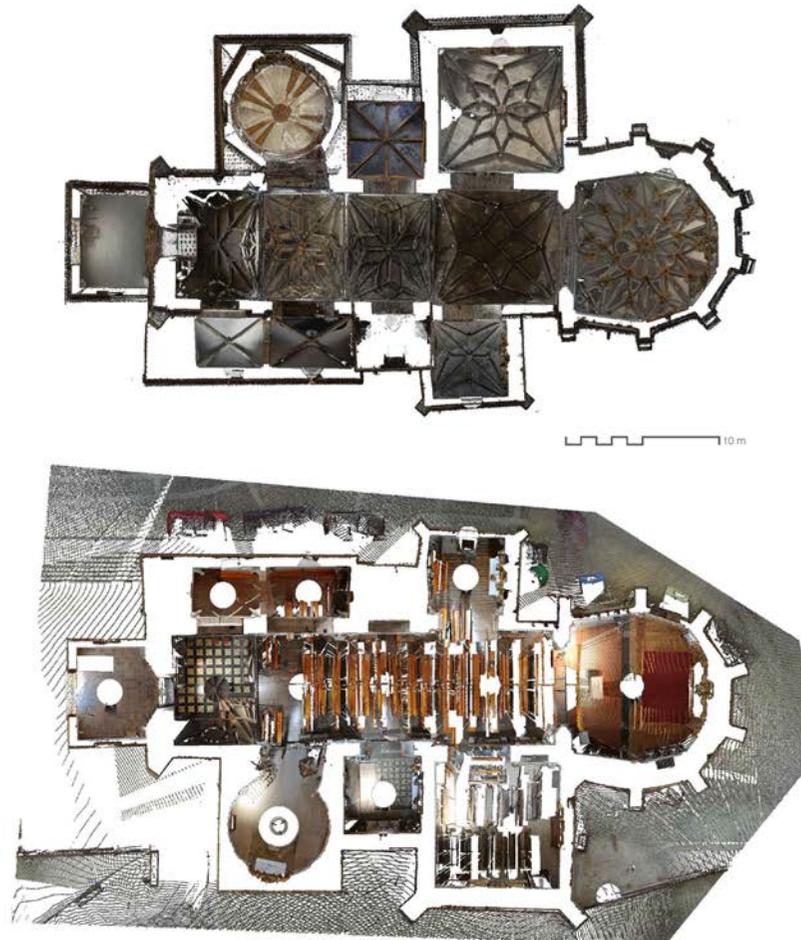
Planta y planta cenital de la iglesia. Fuente: elaboración propia.
